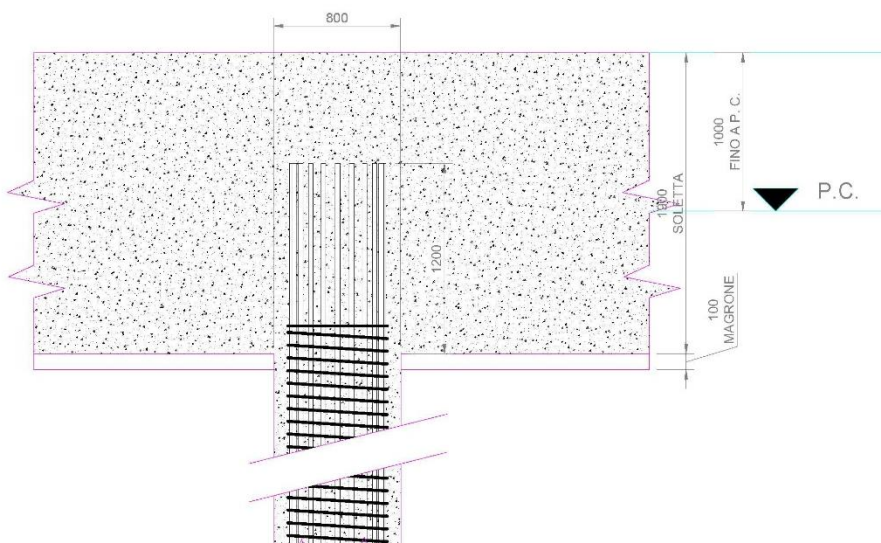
Schema del collegamento tra pali e platea di fondazione
